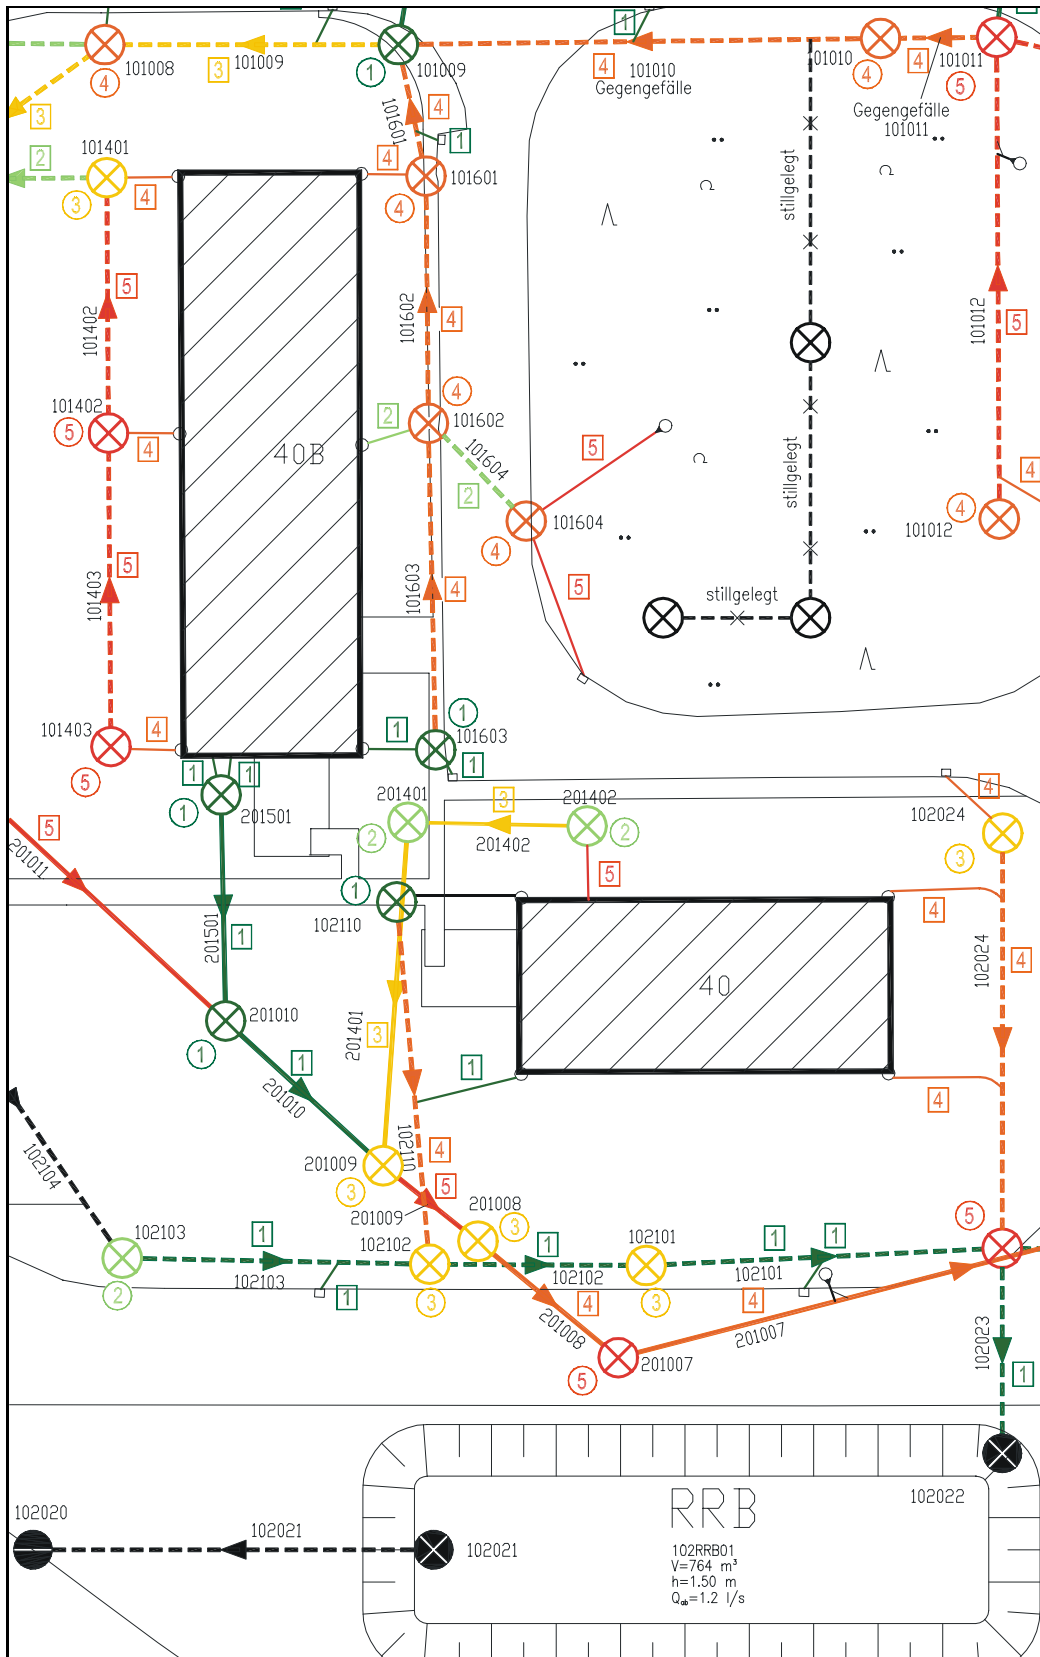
7 Beispielplan: Lageplan "Bautechnische Zustandsbewertung"
